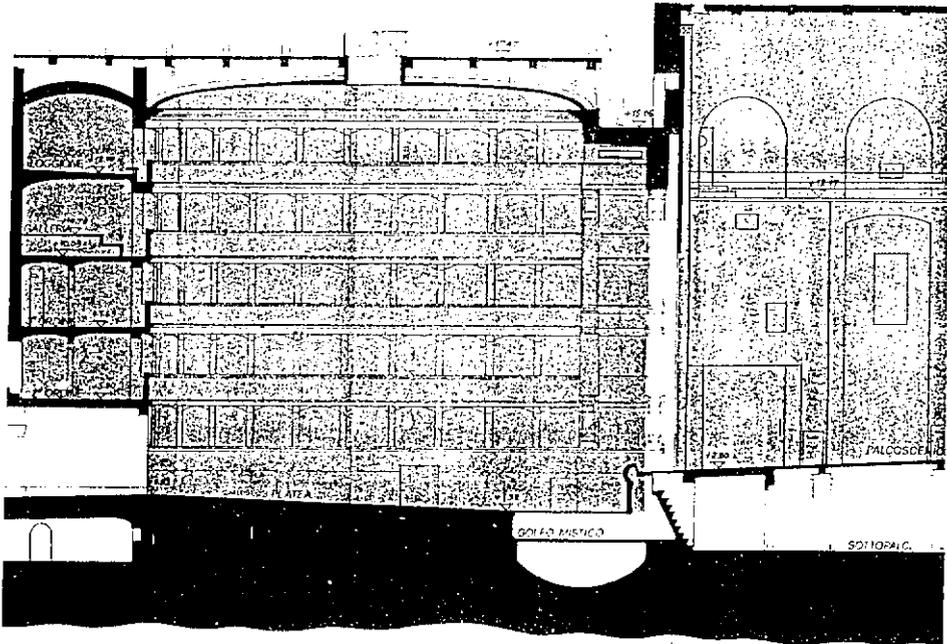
Sezione del Teatro Alighieri - Ravenna
